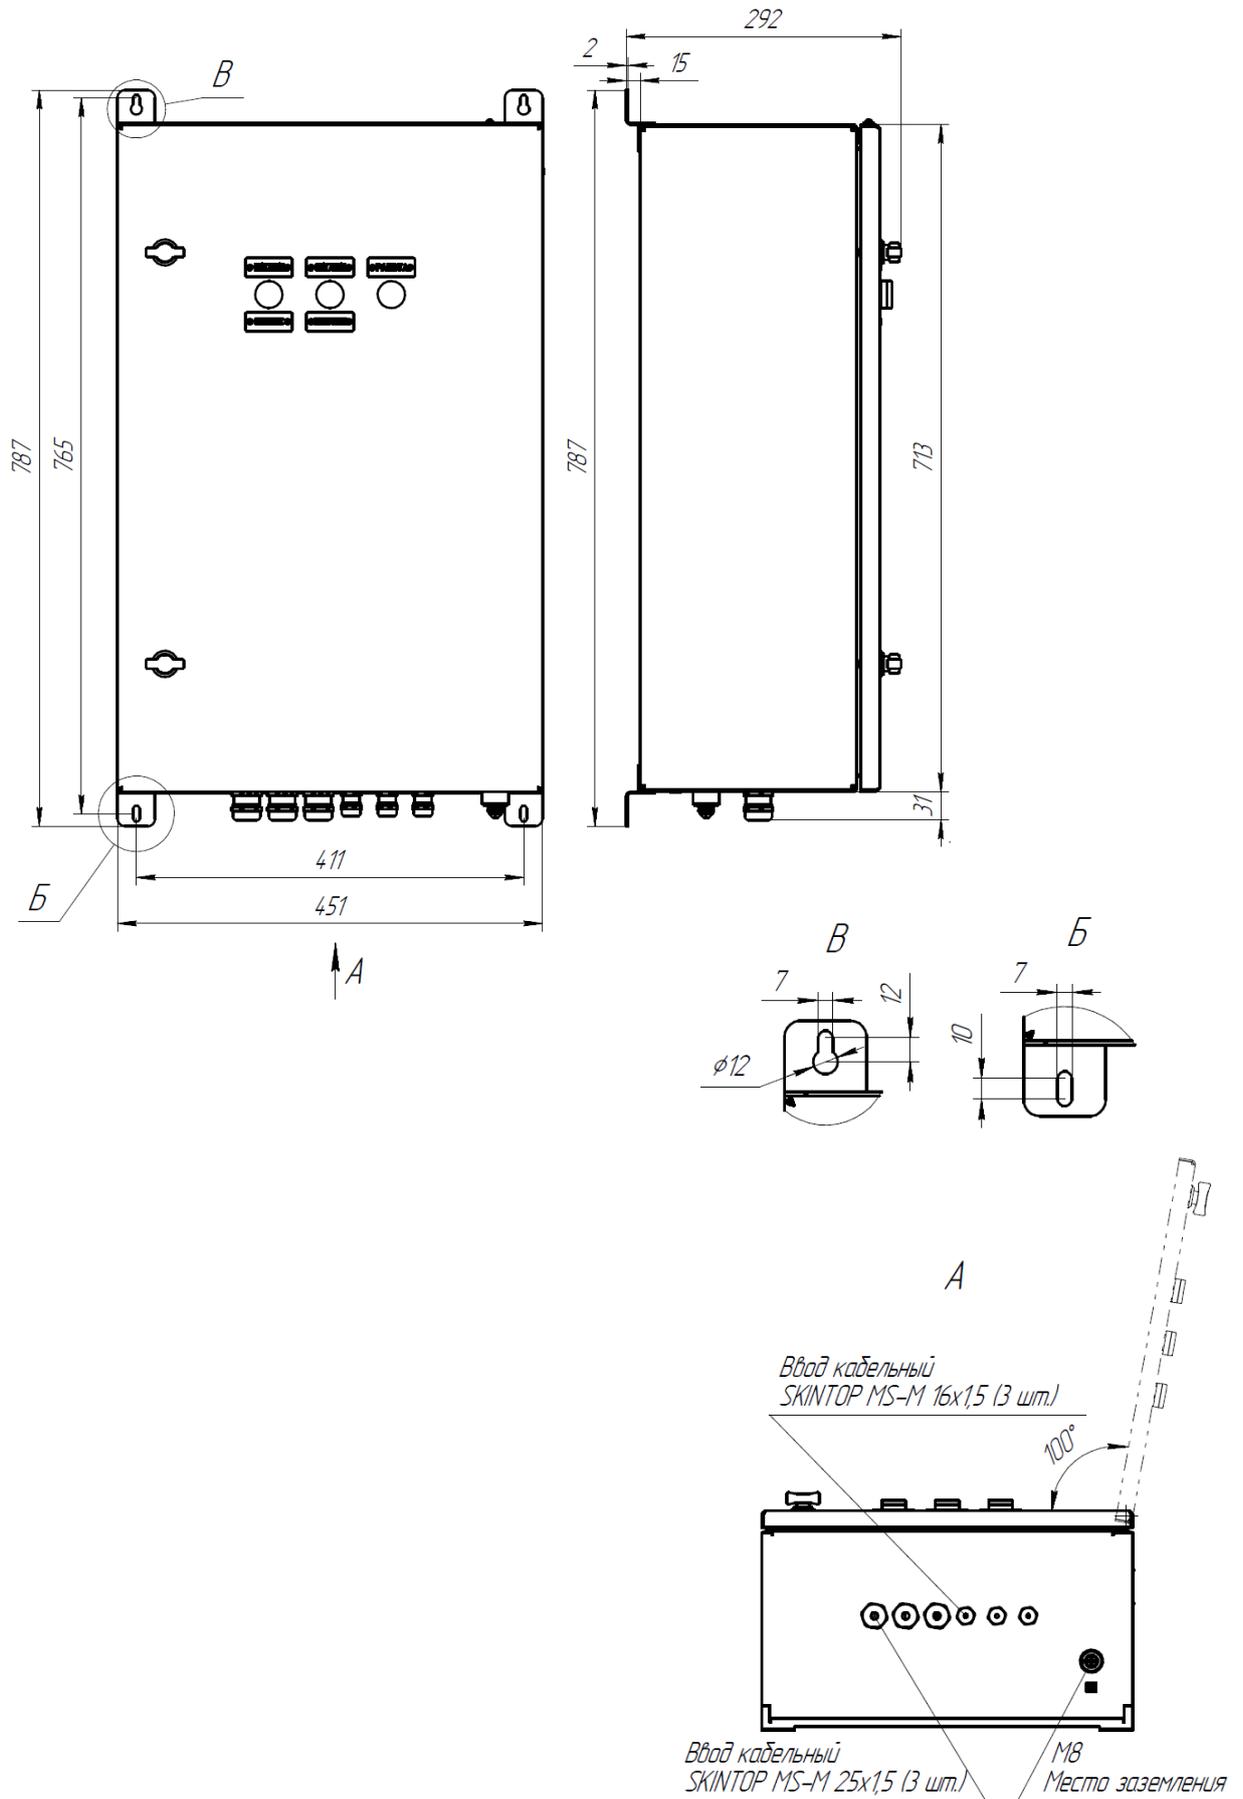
Габаритные и установочные размеры ЩППУ
